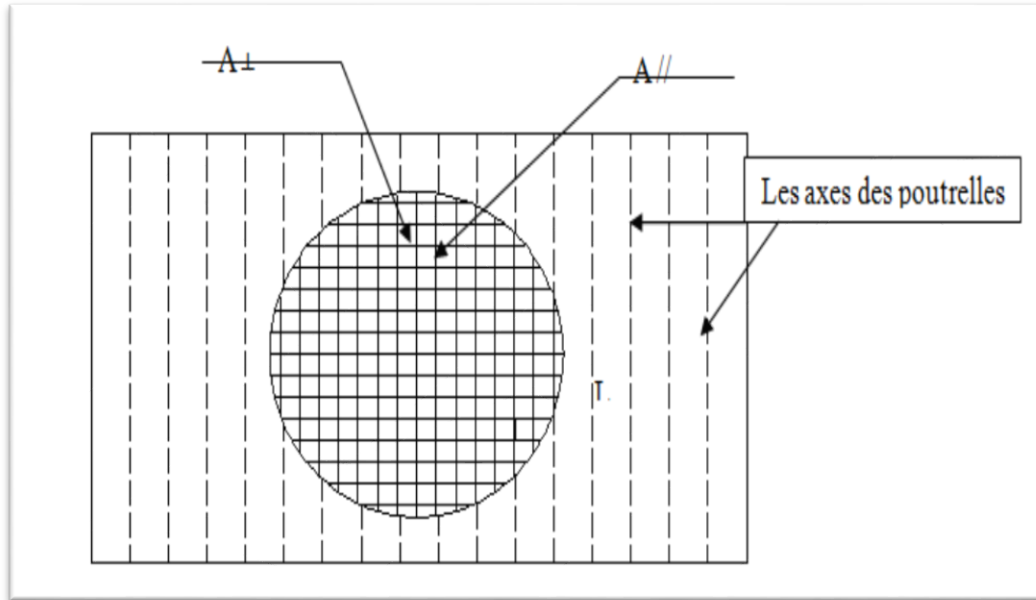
Schéma de ferrailage de la dalle de compression.
